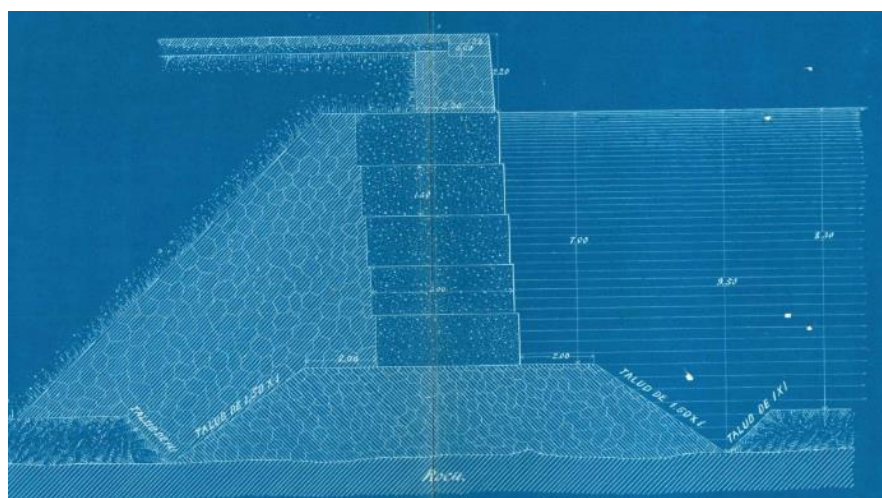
Sección tipo rama corta. Fuente. Hoja nº5, detalles del muelle de la Rama corta del Norte, (7 de abril de 1911)
